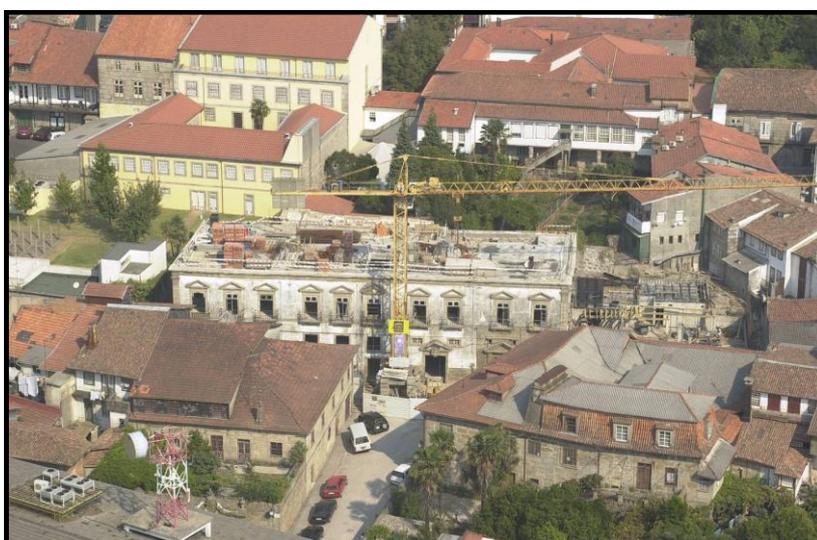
Vista aérea da Casa Navarros de Andrade: durante as obras de adaptação a arquivo (CMG, 2001)
